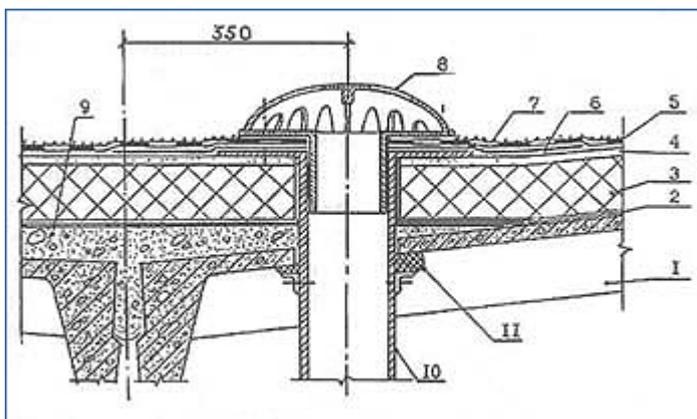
Воронка внутреннего водостока: 1 - сборная железобетонная плита покрытия; 2 - пароизоляция (по расчёту); 3 – теплоизоляция; 4 - выравнивающая стяжка; 5 - основной кровельный ковёр; 6 - дополнительный слой кровельного ковра; 7 - крупнозернистая посыпка верхнего слоя; наплавляемого рулонного материала; 8 - колпак водоприемной воронки; 9 - легкий бетон выравнивающего слоя ендовы; 10- водоприемная чаша; 11- уплотнитель.
